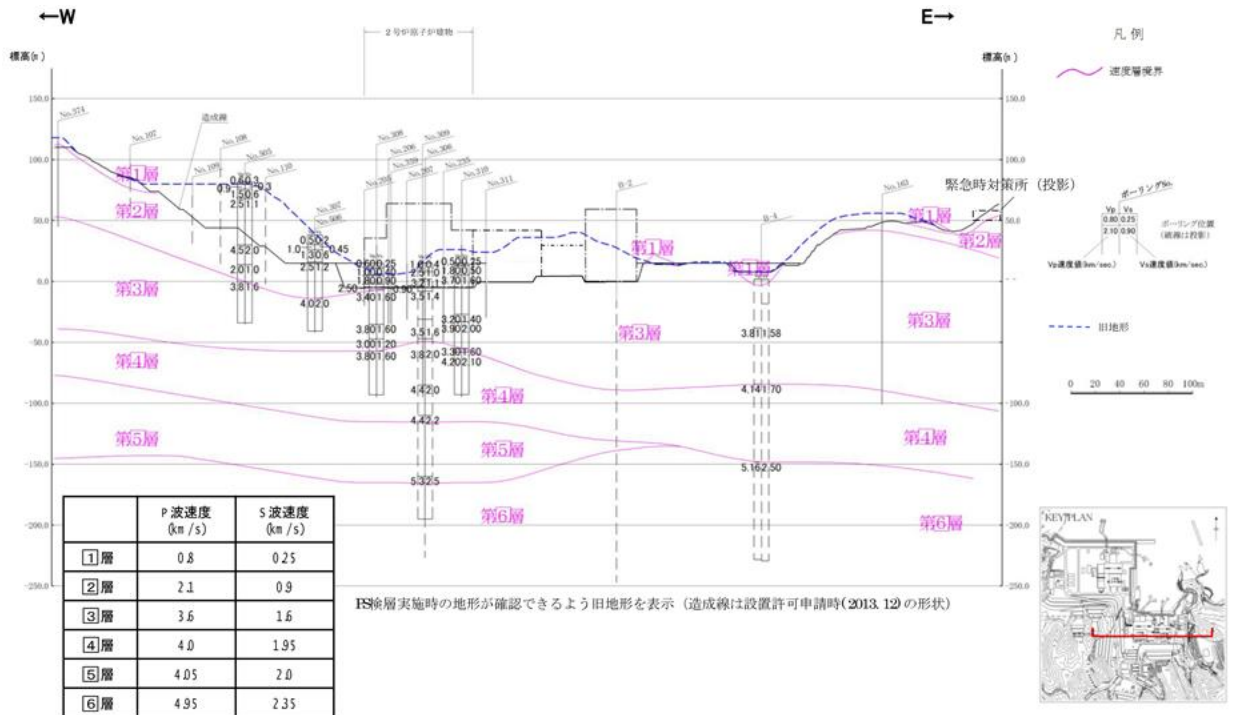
原子炉建物基礎地盤の速度層断面図（東西断面）
